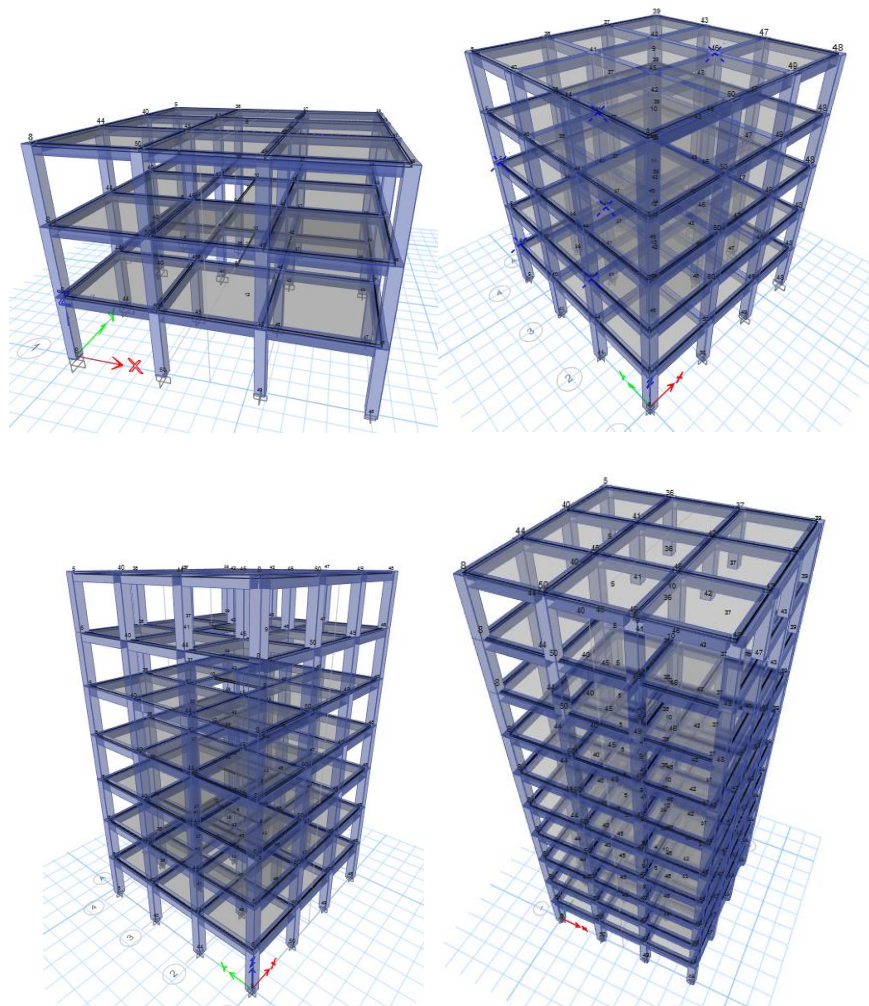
Prototipos de estructuras de pórticos de 3, 5, 7 y 10 pisos.
